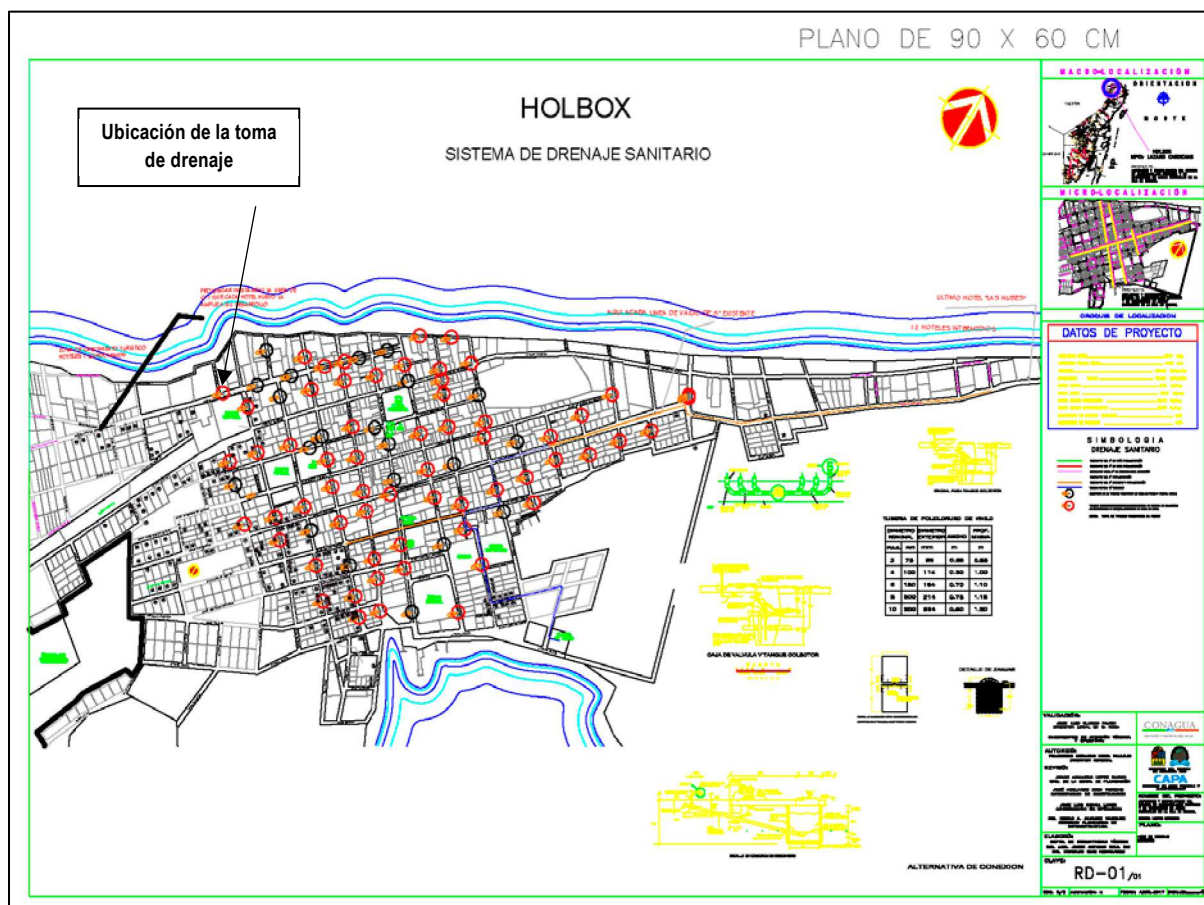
plano de ubicación de registros de las tomas de drenaje existentes en la Isla de Holbox
